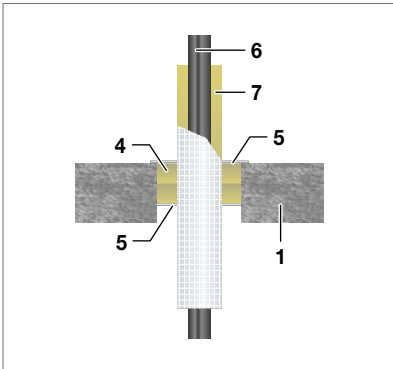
Weichschott in der Massivdecke mit Viega Rohrleitungssystem Kunststoff
